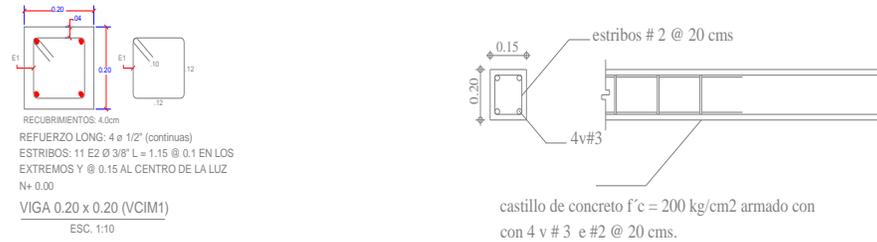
Elementos estructurales de las vigas para la iglesia San isidro
